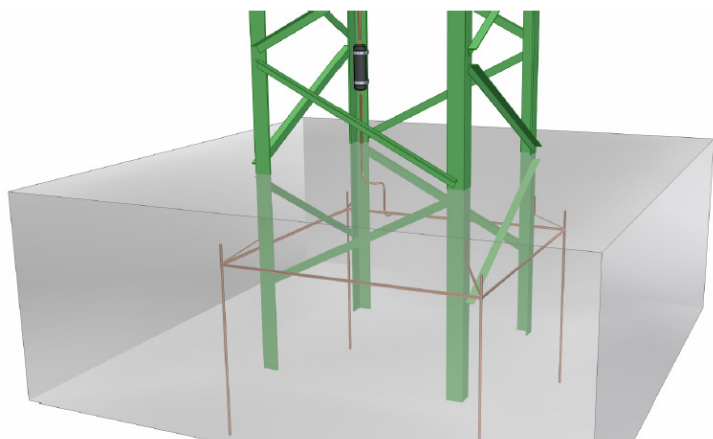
Instalación tipo filtro dinfil en el cable bajante del DDCE para su protección.
